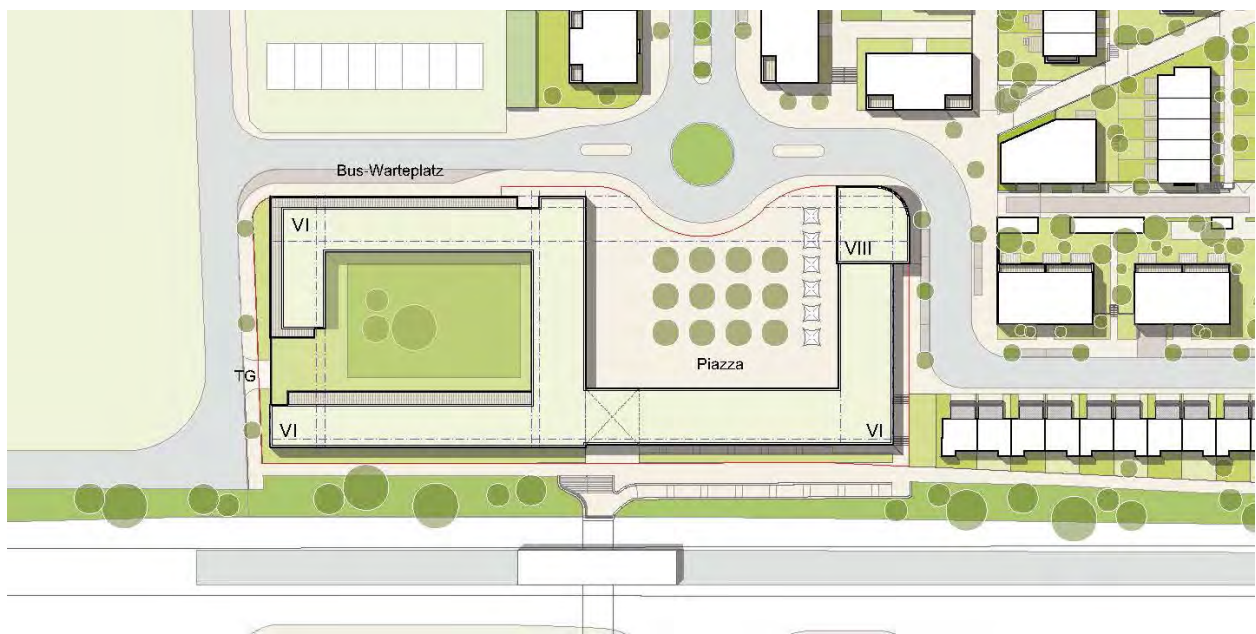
Ausschnitt aus dem Bebauungskonzept des Investors Quelle: Baufrösche Architekten und Stadtplaner GmbH
